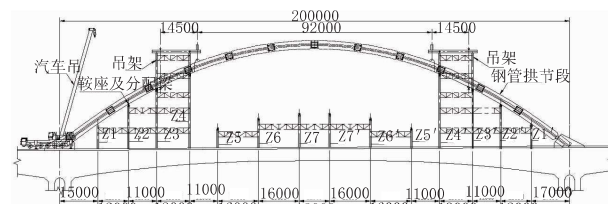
拱肋提升支架施工步骤三布置图(单位:mm)
